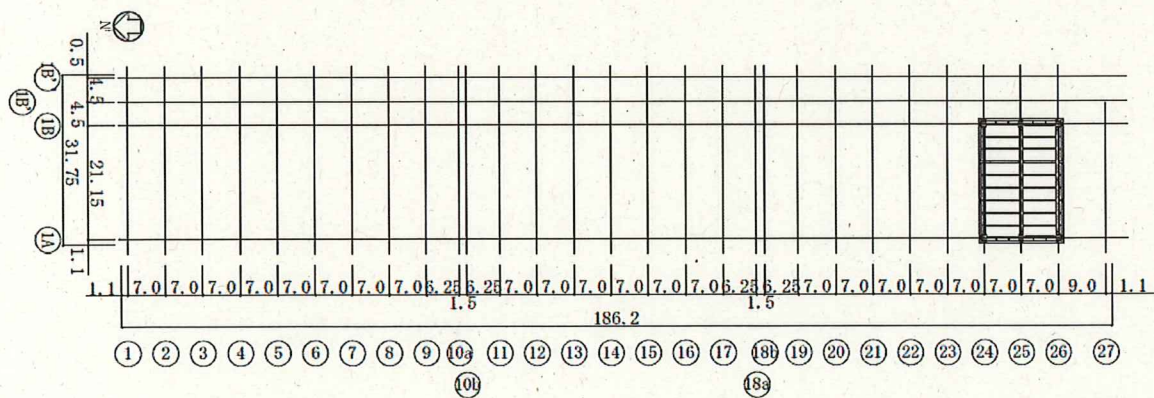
(4) 屋上階平面図 (G.L. +22.850) (単位 : m)
